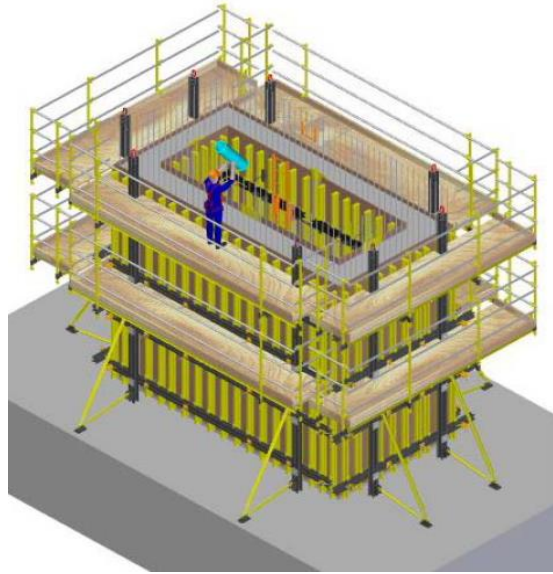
j. Detalle del colado, una vez armada la primera tongada. Recuperado de: Ulma Construction, *Instrucción técnica de montaje.
